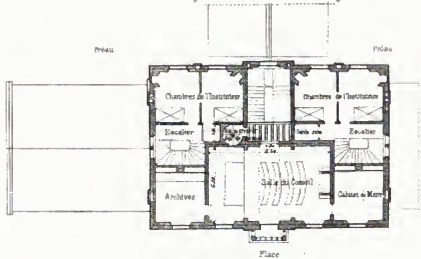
(Ech. 1/50) Plan du 1^{er} Etage
